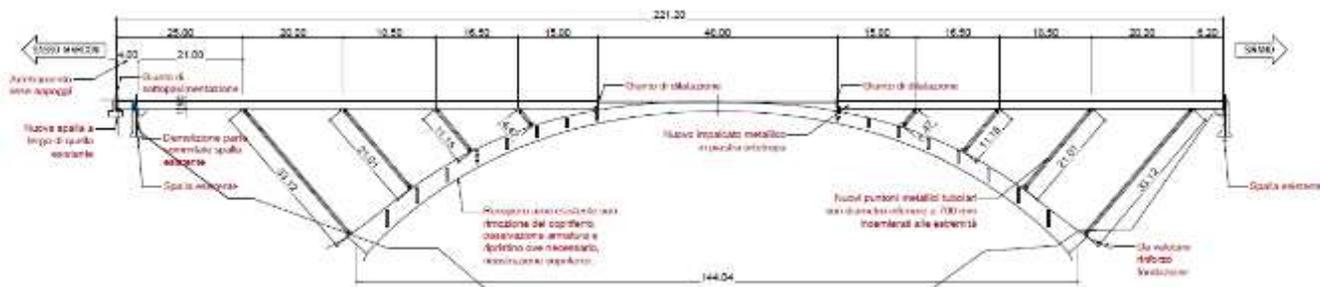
Nuovo ponte Leonardo da Vinci – Prospetto longitudinale
